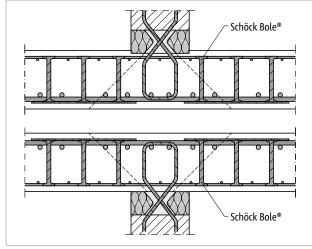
Schöck Sconnex® Typ W-N: Indirekte Lagerung der Schöck Sconnex®, mit Schöck Bole® bewehrt
